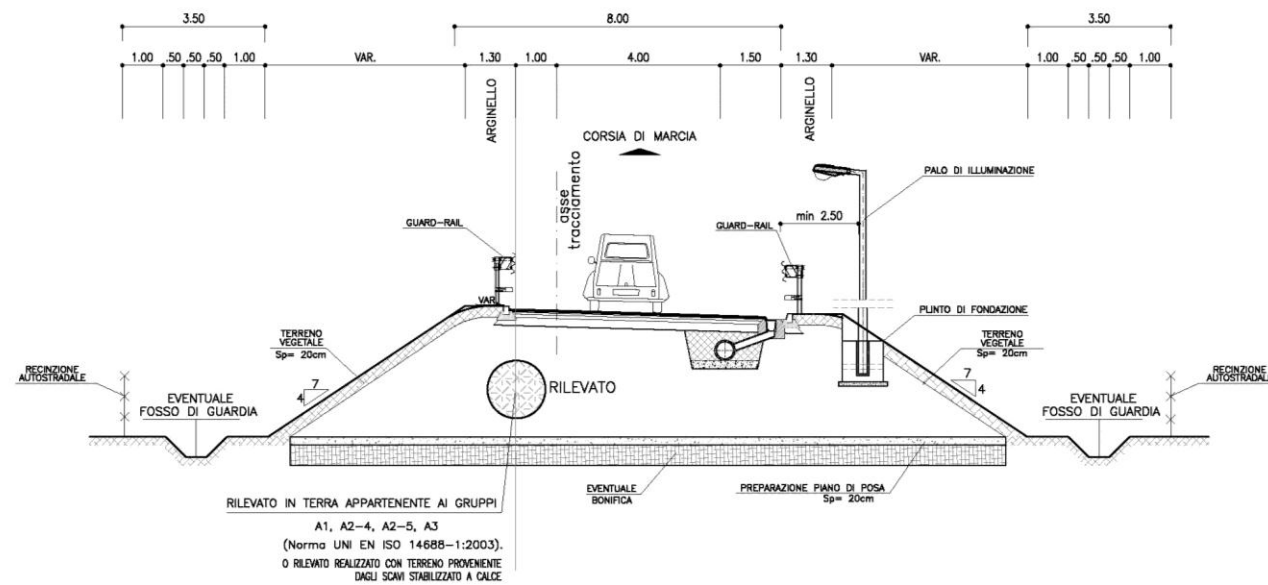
Sezione tipo rampa monodirezionale in rilevato
